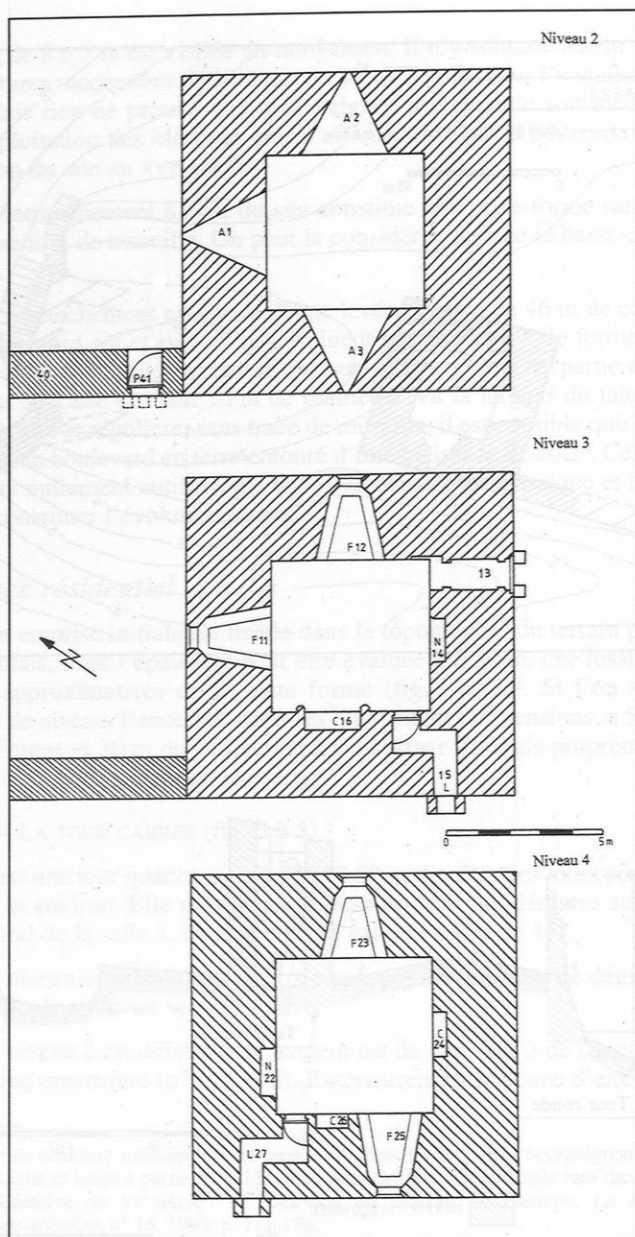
Tour carrée. Plans par niveaux. Légende : A : archère ; F : fenêtre ;
